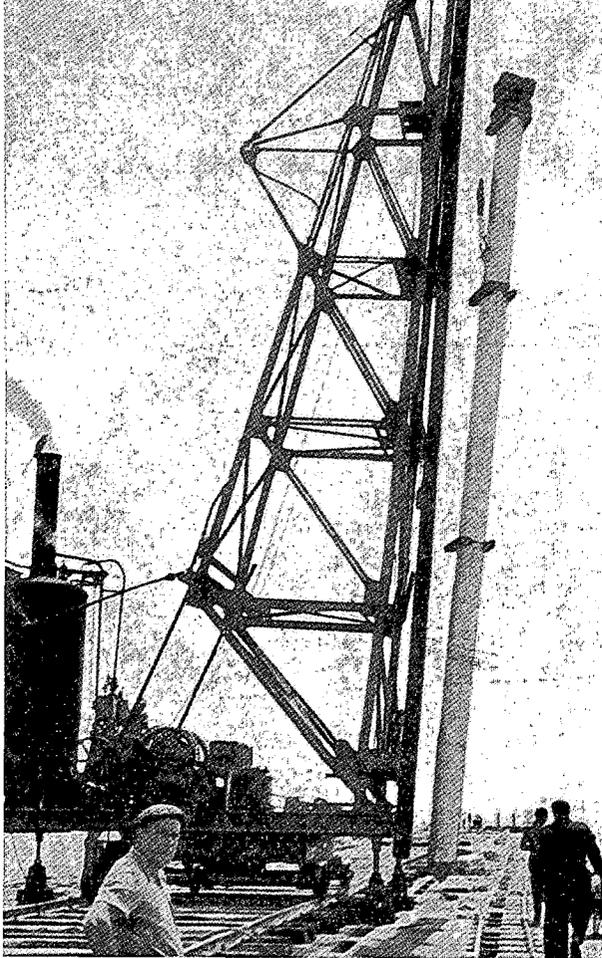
Pantalán con pilotes prefabricados de hormigón armado. Fuerzas motrices (Barcelona).
